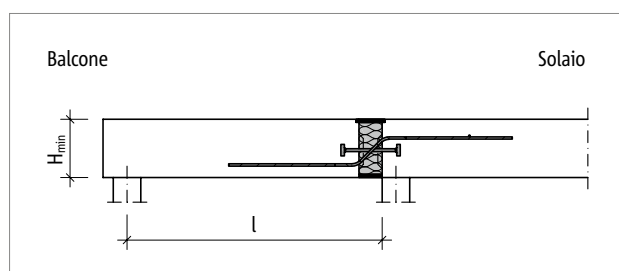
Schöck Isokorb® T tipo QP: sistema statico
